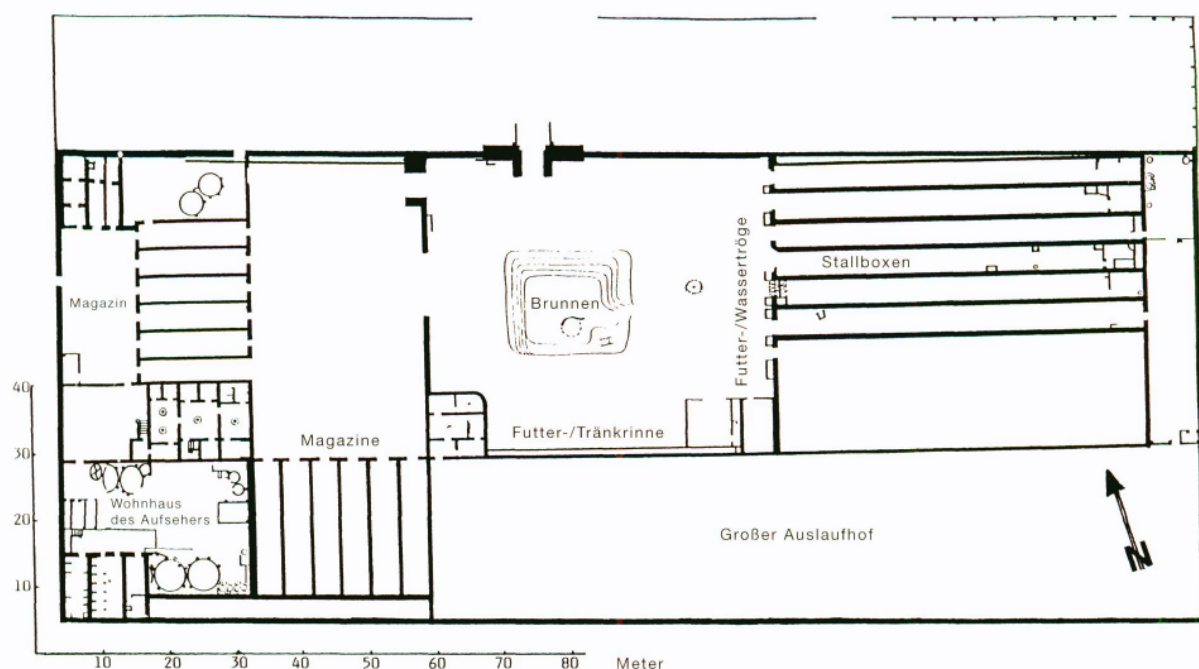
Plan eines Stallgebäudes in El-Amarna
